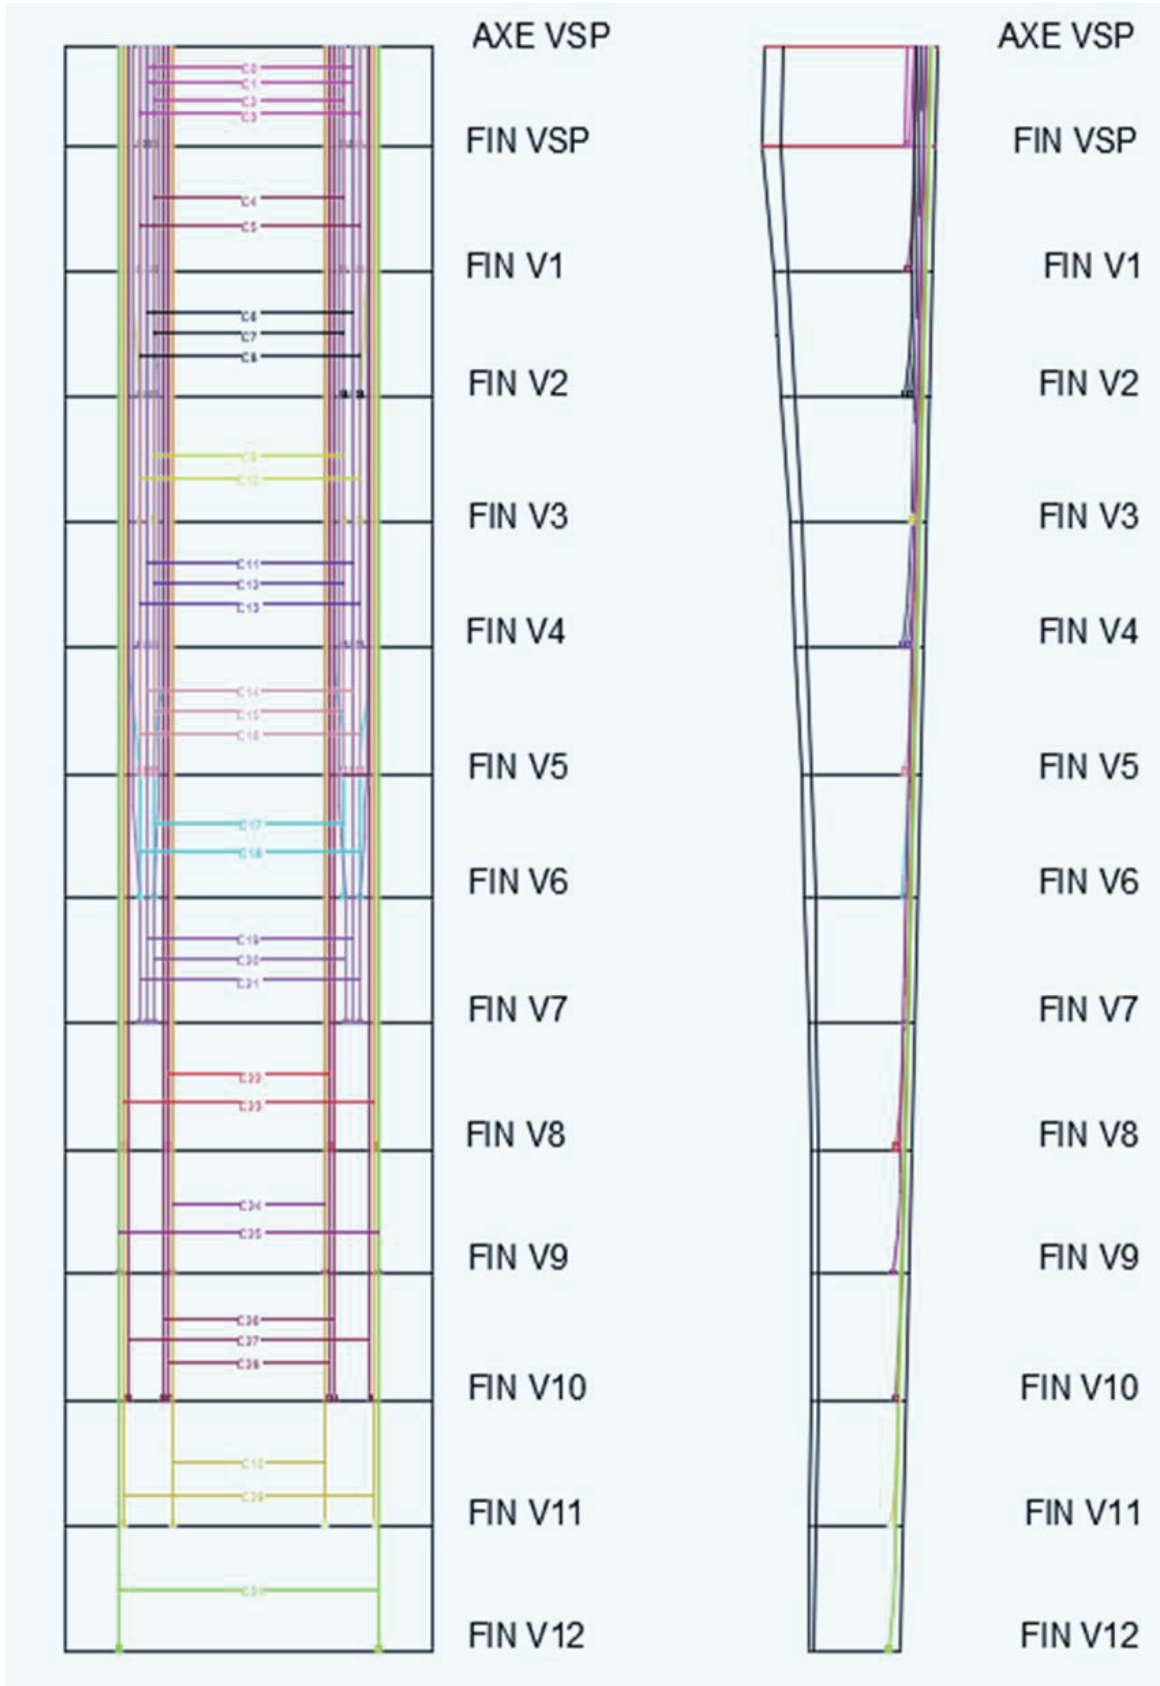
Tracé En Plan et en élévation des Câbles de Fléau
